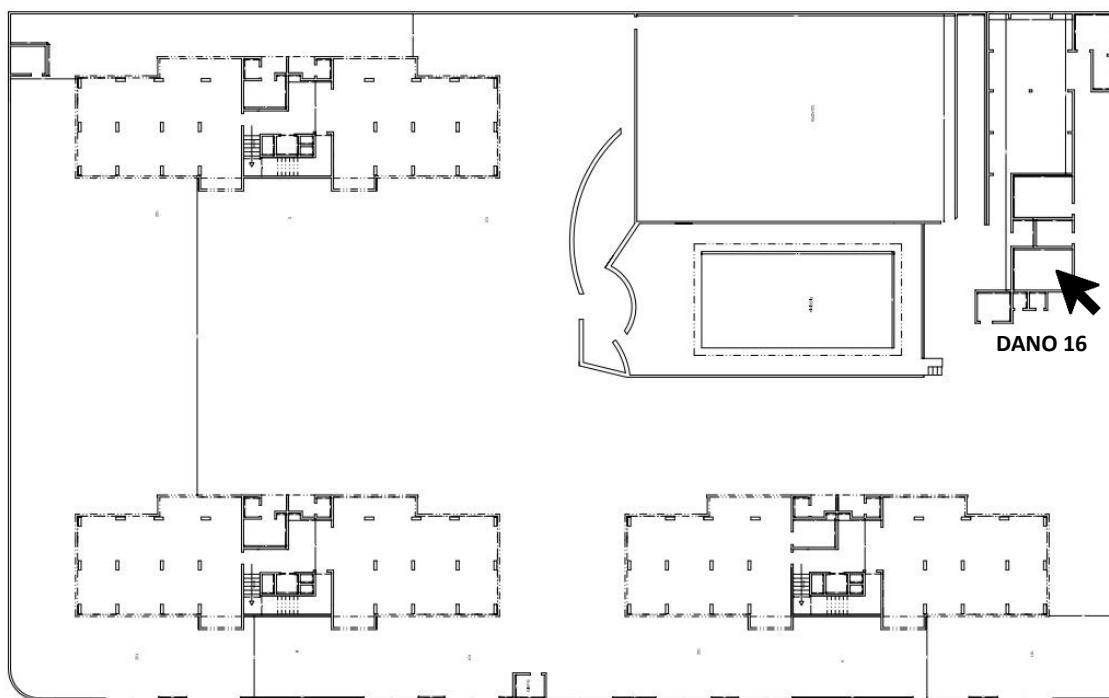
Área comum Cond. Armando Lobo (próximo ao Bloco A)
